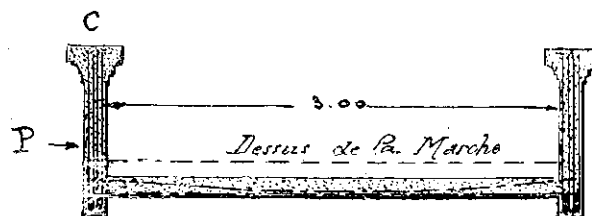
ESCALIER EN CIMENT ARMÉ, Coupe transversale.
